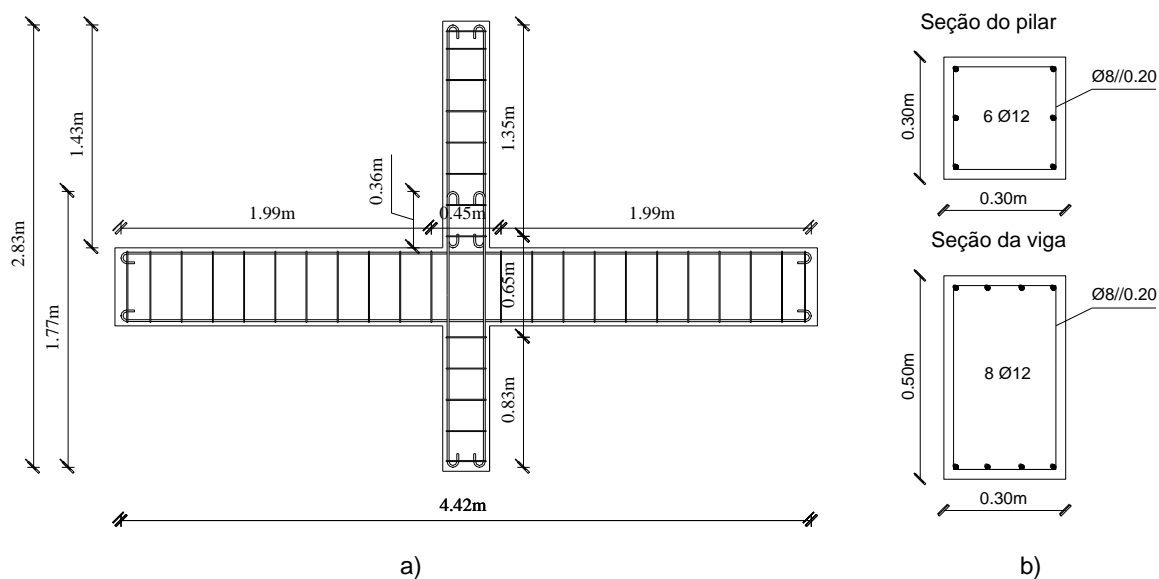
Armadura do provete IPB; a) em planta; b) em corte..
